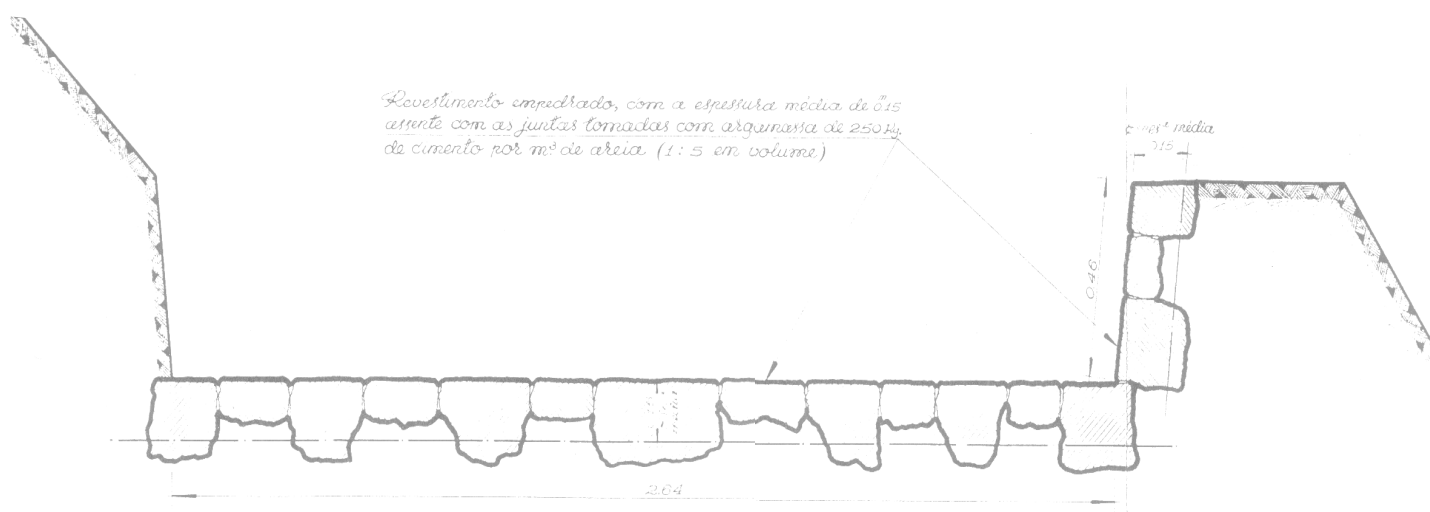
Perfil transversal do canal de Este e das obras previstas para a sua reconstrução.
